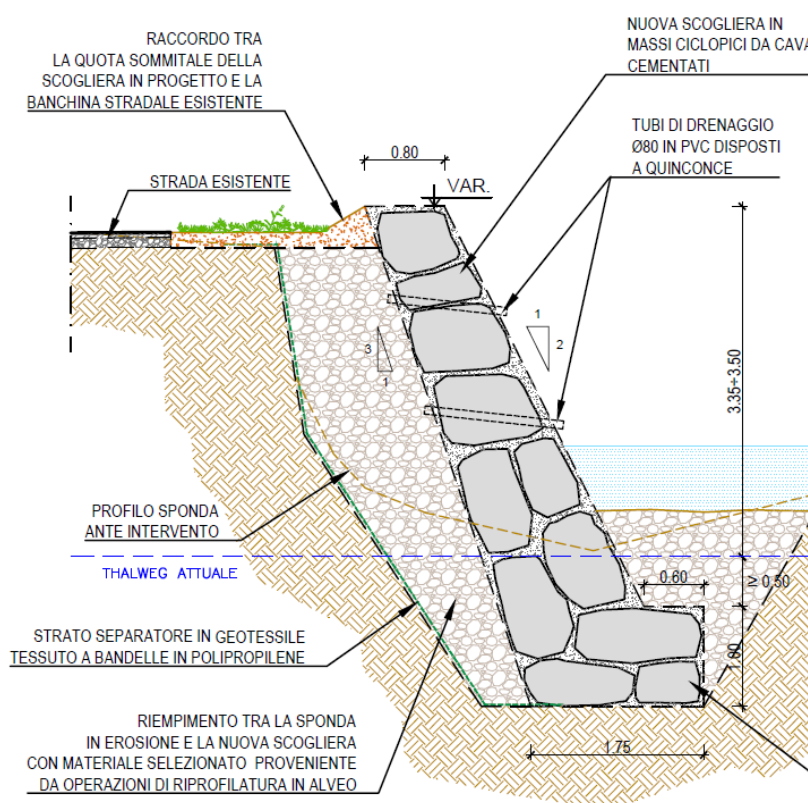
Sezione tipo delle scogliere oggetto di intervento, lato monte dell'intervento.
